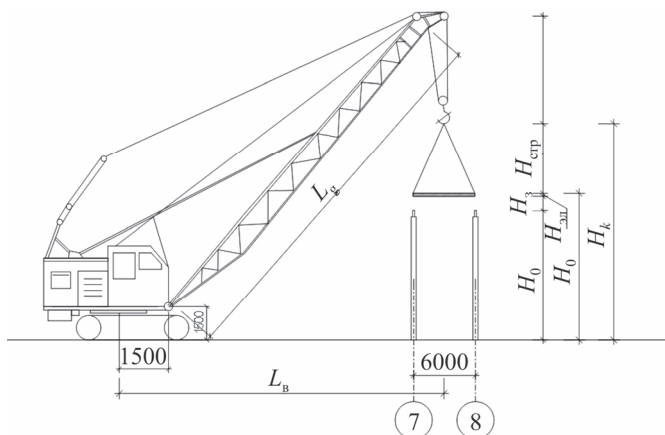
Расчетная схема монтажа плиты покрытия с применением стрелового крана
